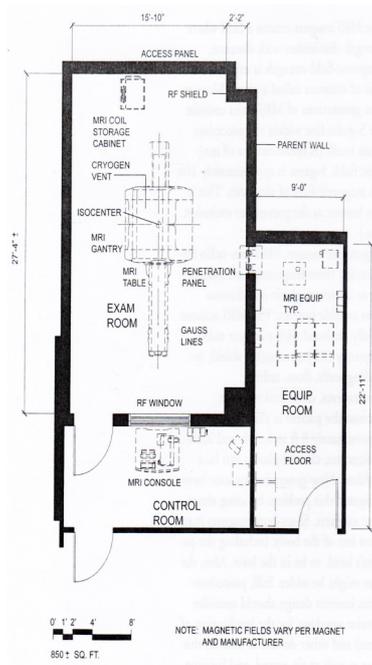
Exemplo de planta baixa de uma sala de RM. Fonte: KOBUS et al, 2008.
